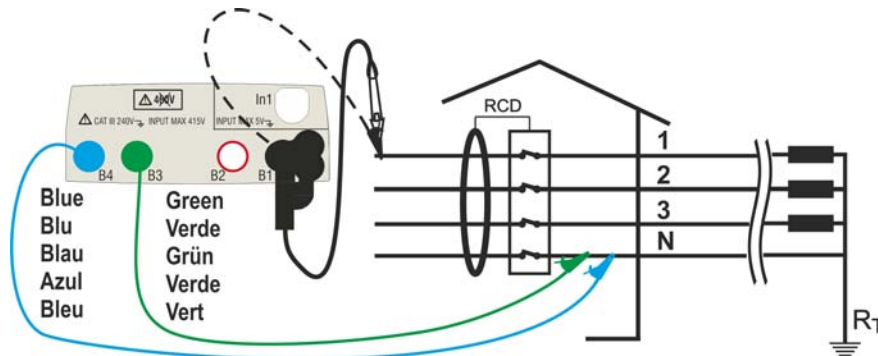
Connexion en système 400V+ N (sans PE) par câbles simples et embout à distance (Non RCD de type B)
